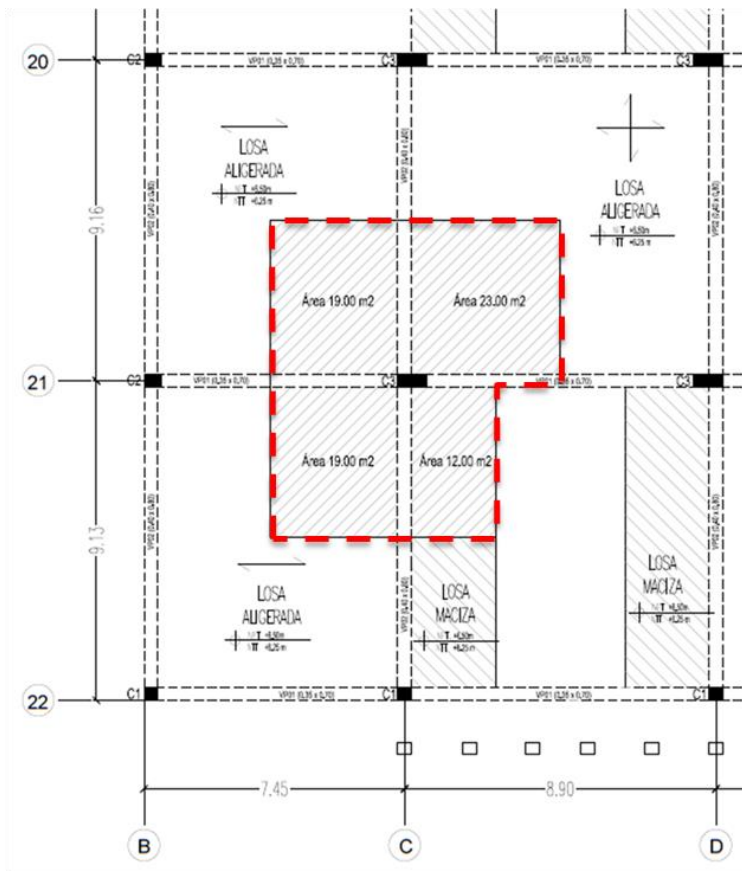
Área de influencia de columna C-3, en los pisos 1, 2 y techo.
